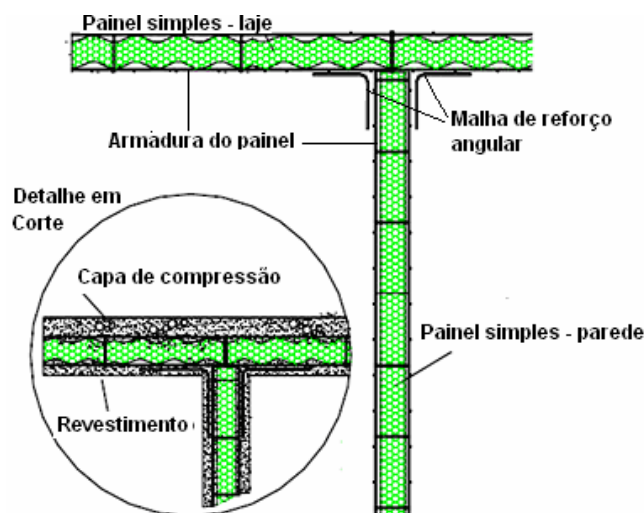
Encontro de painel parede com painel laje – laje plana
